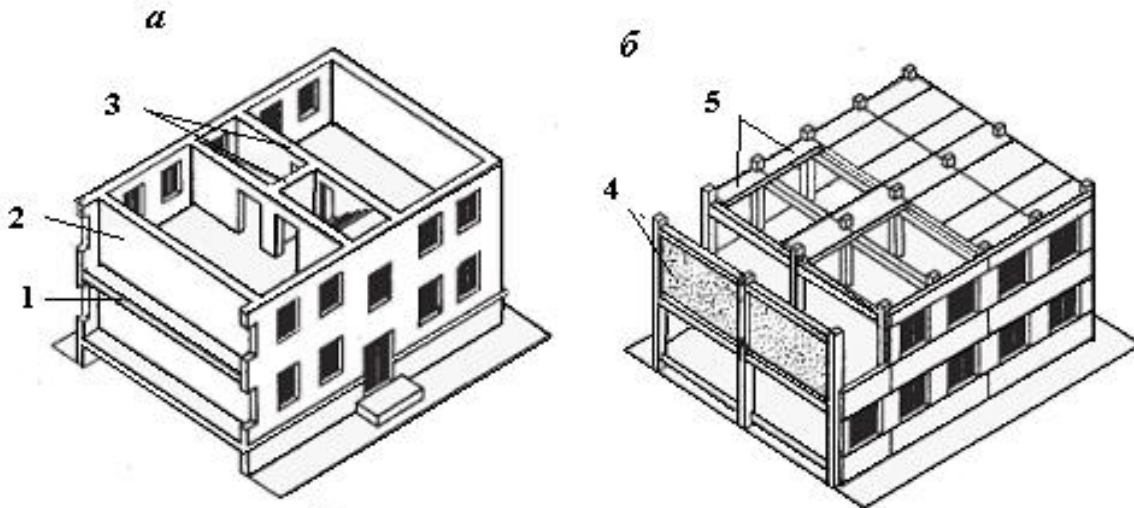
Конструктивні елементи, які забезпечують просторову жорсткість будівлі: а – безкаркасної; б – каркасної; 1 – міжповерхове переkritтя; 2 – поперечна стіна; 3 – стіни сходової клітки; 4 – стінки жорсткості; 5 – плити розпірки
